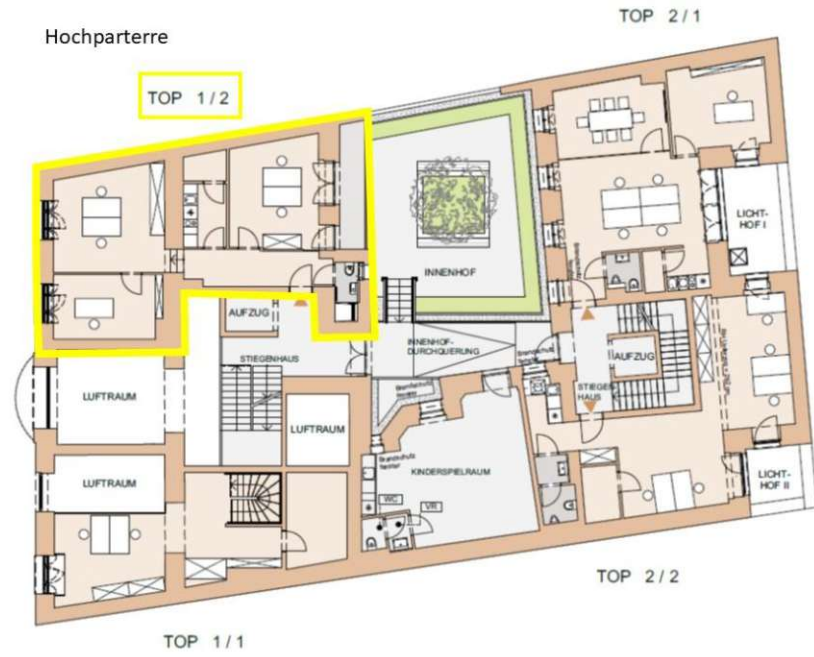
Grundriss Hochparterre Kleine Spargasse 5. Quelle: ARE
